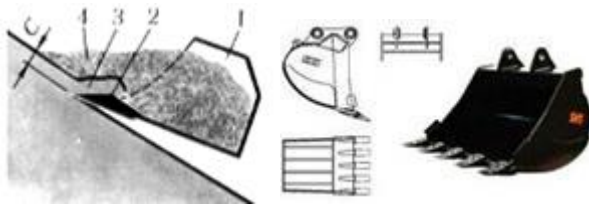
Копання ґрунту ковшем екскаватора: 1 - корпус ковша, 2 - ріжуча частина (зубці), 3 - стружка, 4 - призма волочіння, С - товщина стружки
